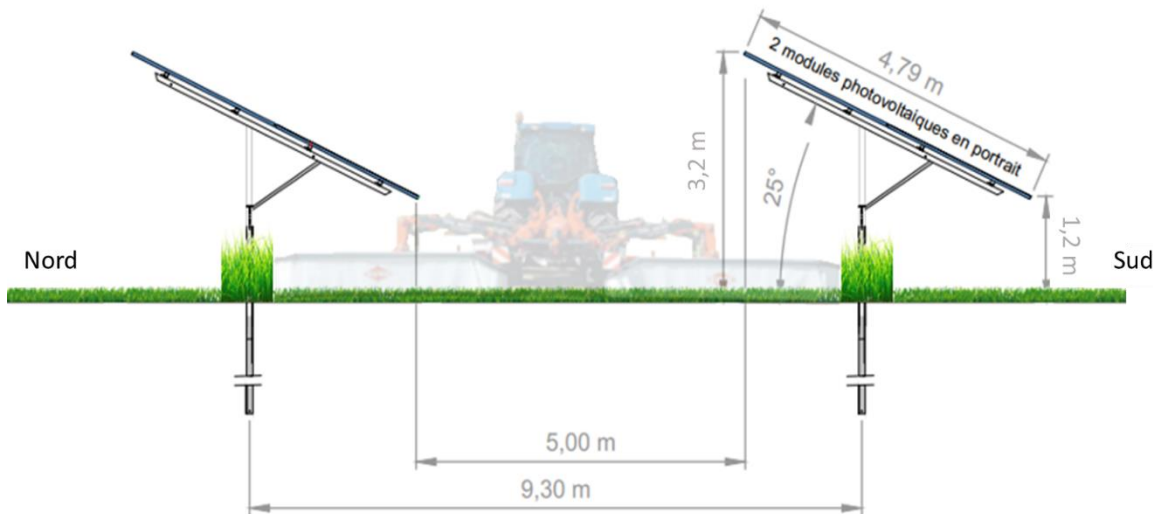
Exemple d'implantation de panneaux solaires sur une prairie
